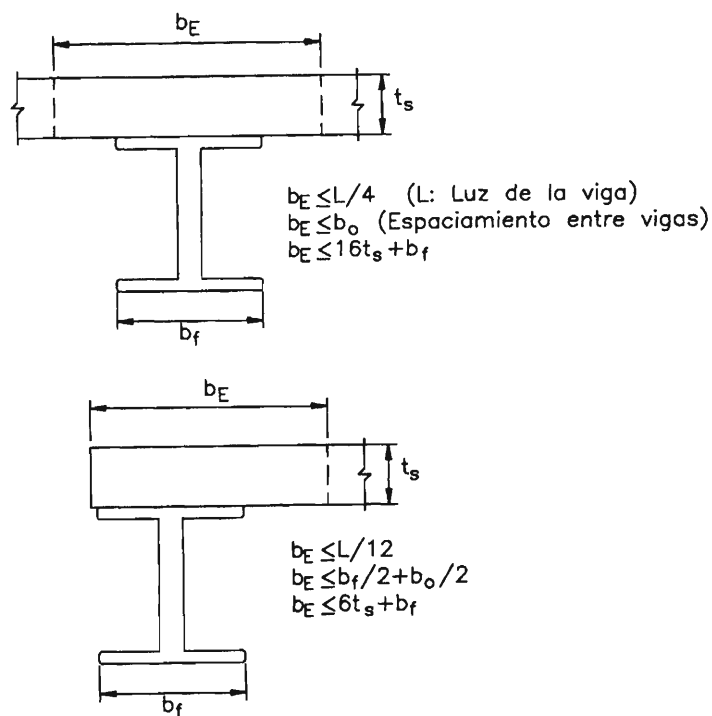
Ancho efectivo de la losa que contribuye a la resistencia de la viga
